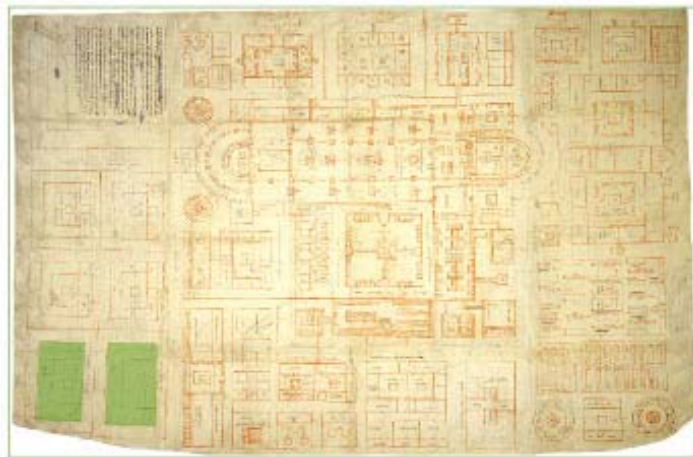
Klosterplan, Planausschnitt Stallungen Kühe/Kälber und Stuten/Fohlen
